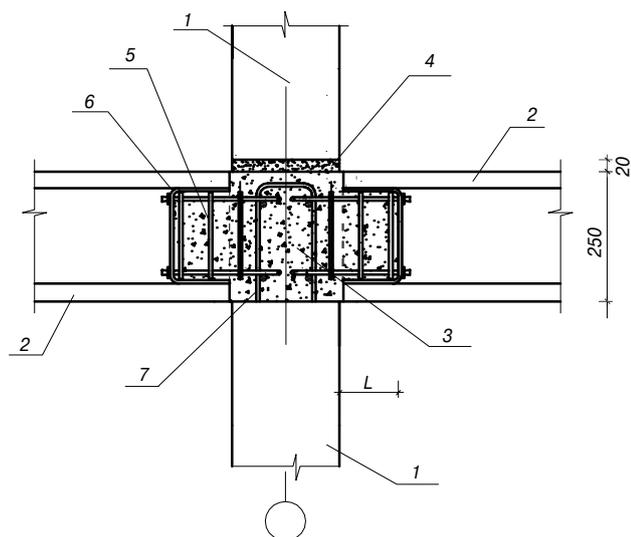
Контактно-платформенный стык сборных стен с вынесенными за плоскость стены зонами опирания многопустотных плит: 1 – стеновая панель; 2 – плита перекрытия; 3 – монолитный бетон; 4 – цементно-песчаный раствор; 5 – каркас армирования шпонки; 6 – пластиковая заглушка; 7 – арматурные выпуски из стеновых панелей; L – участок подвески перекрытия (расчетная величина)
